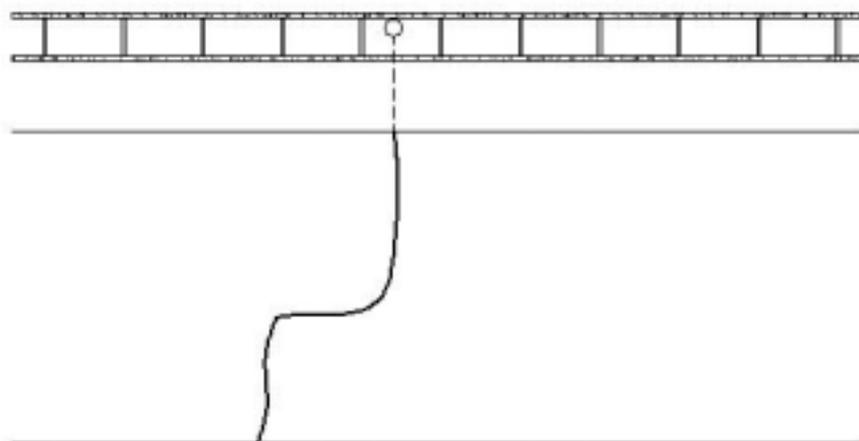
Fissura provocada pela retração da alvenaria, em seção enfraquecida pela presença de tubulação
